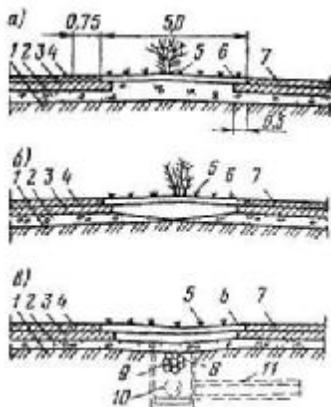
Типовые конструкции укрепления обочин:
